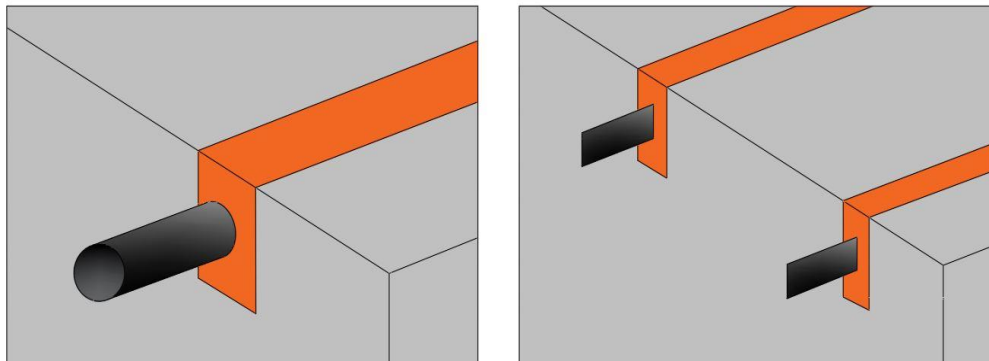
Barras e laminados de FRP aplicados na técnica NSM
